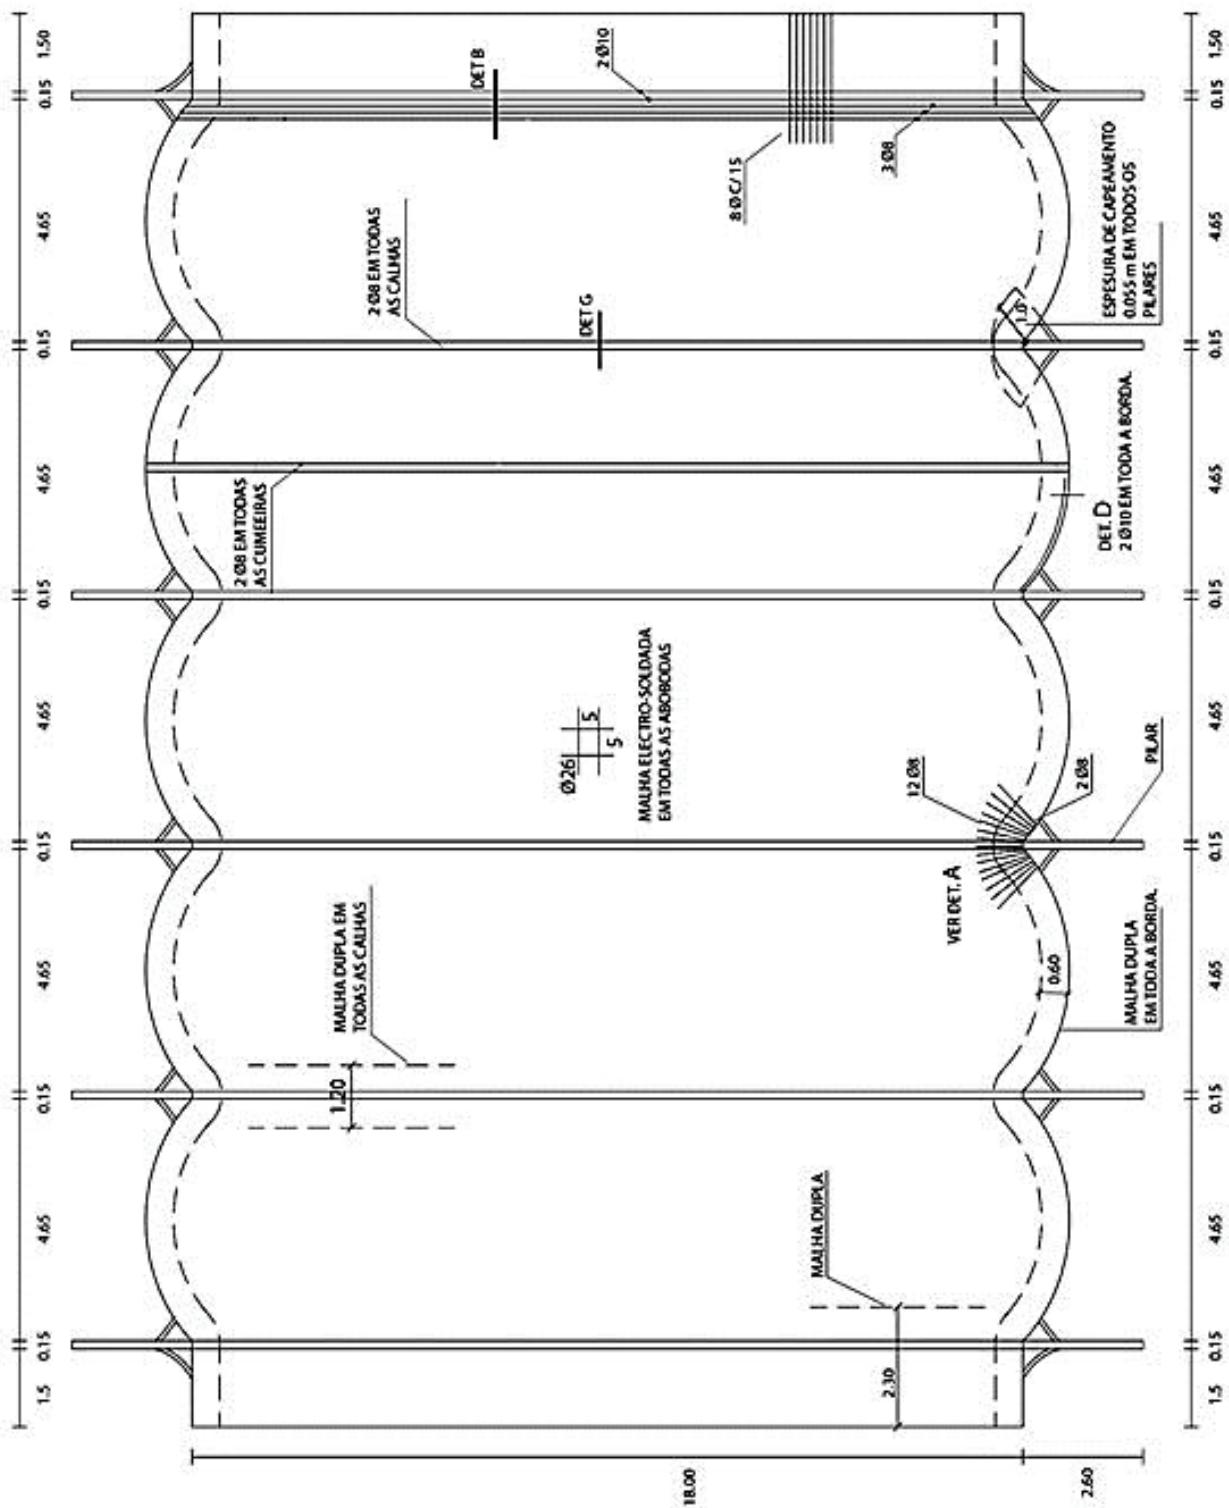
Planta da cobertura com armaduras. (*-5).
